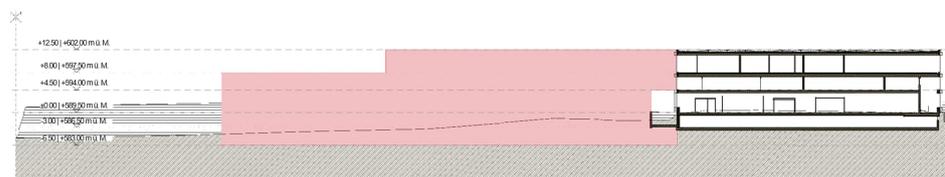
Situationsplan Erweiterung Geschäftsgebäude, Längsschnitt
